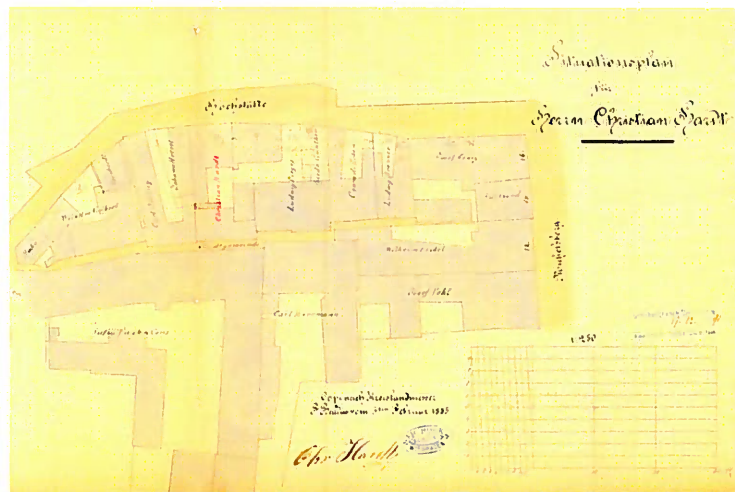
Wiesbaden, Hochstättenstraße um 1885, Bauakte Stadt Wiesbaden
